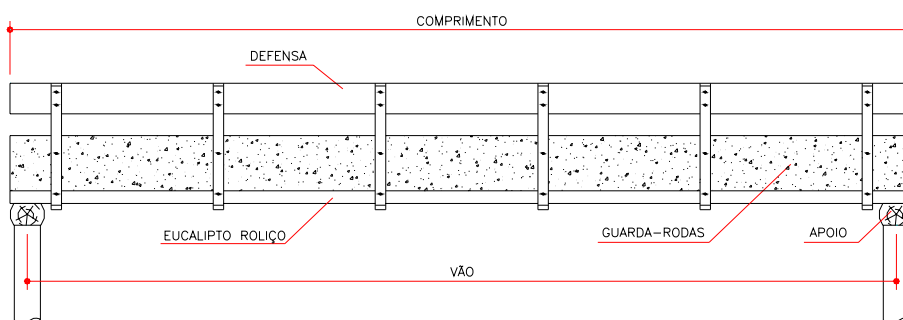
Vista lateral da ponte em placa mista madeira-concreto
